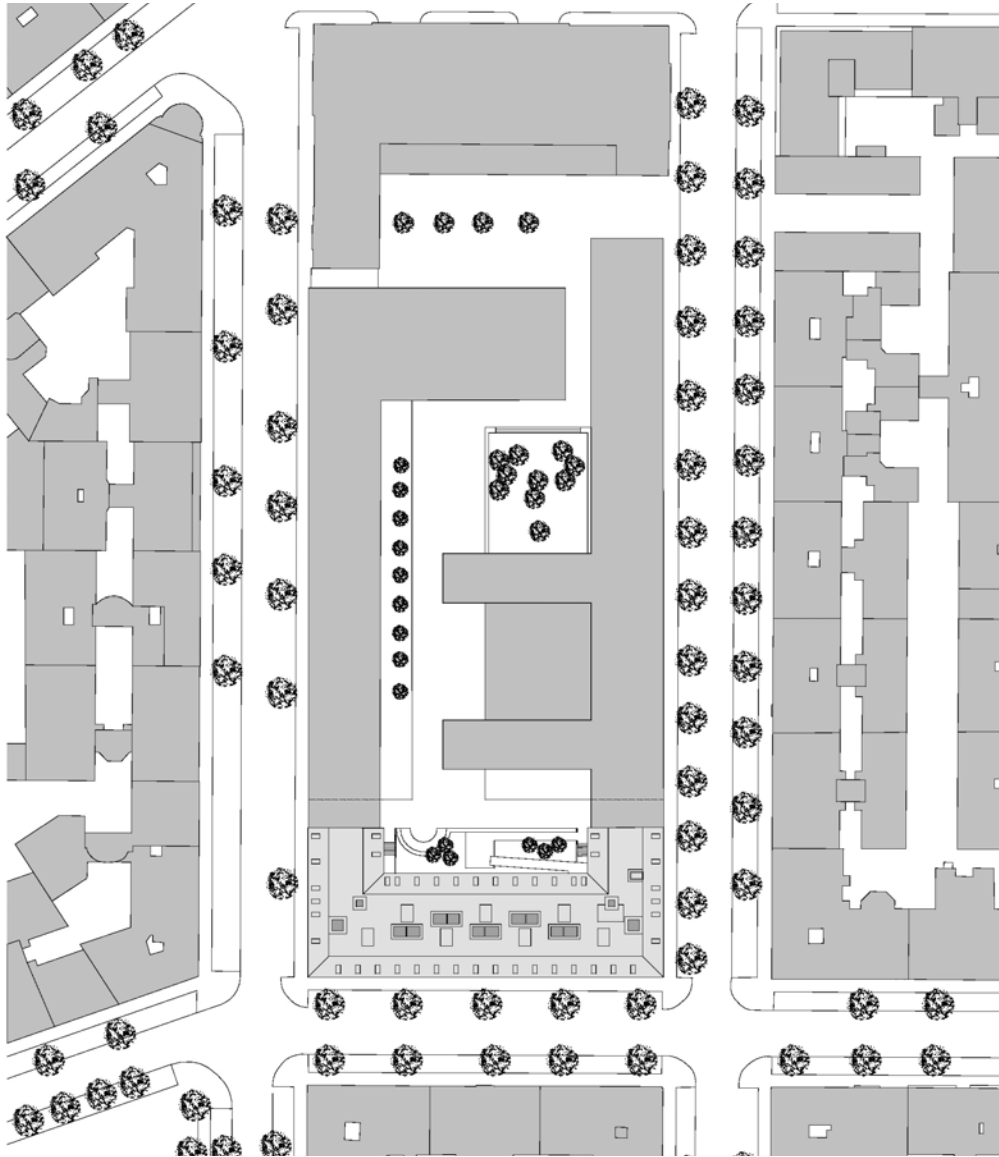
Lageplan Molkerestraße, Baumschlager Eberle
